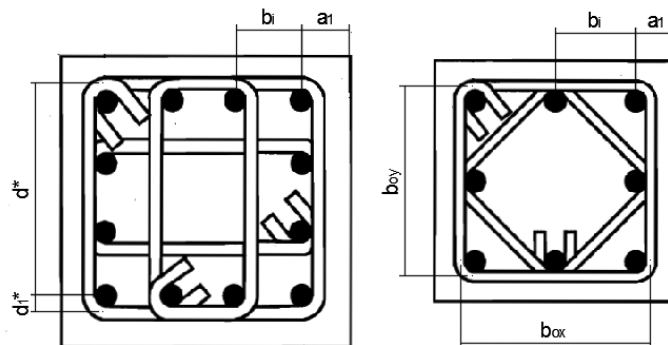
Dimensões da secção confinada (adaptado de Negro et al. (1996)).
